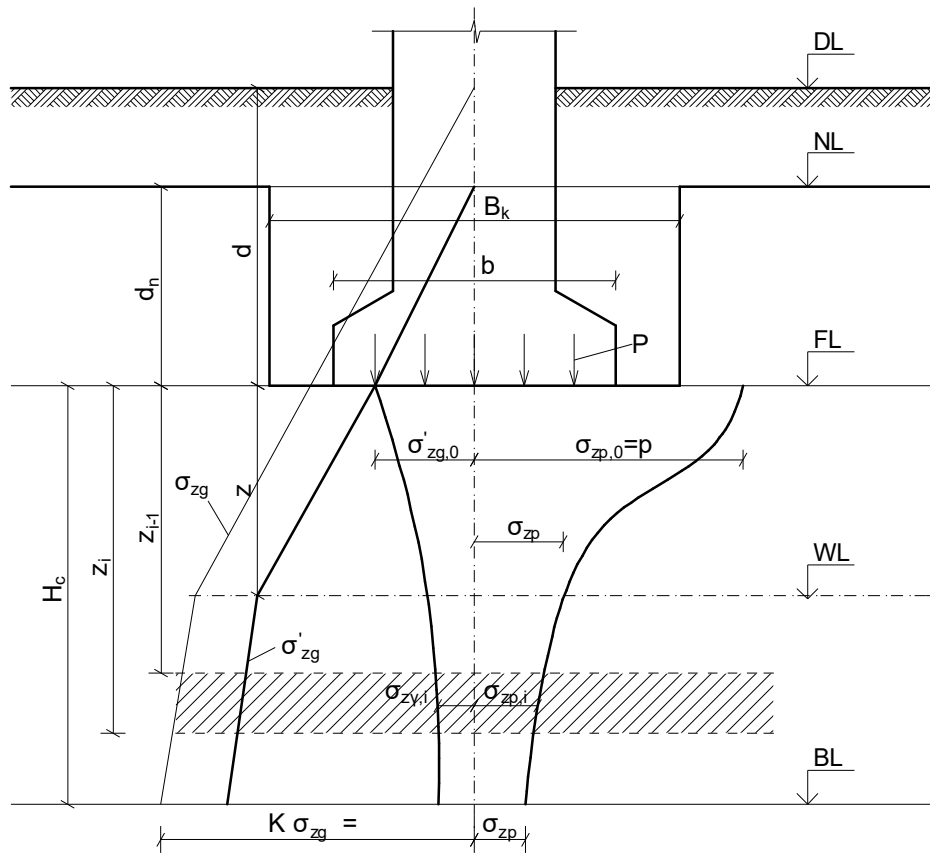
Епюри напружень під подошвою фундаменту за методом пошарового підсумовування
